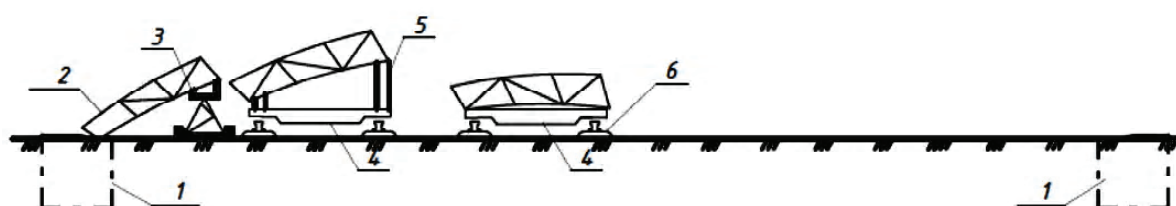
Монтаж с предварительным укрупнением и монтажом на подвижном телескопическом портале: 1 – фундамент; 2 – монтажный блок арки; 3 – монтажные подмости; 4 – подвижные порталы с телескопическими опорами; 5 – домкраты; 6 – рельсы.
